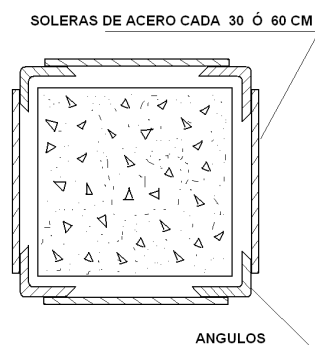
Apuntalamiento con ángulos y soleras de acero
